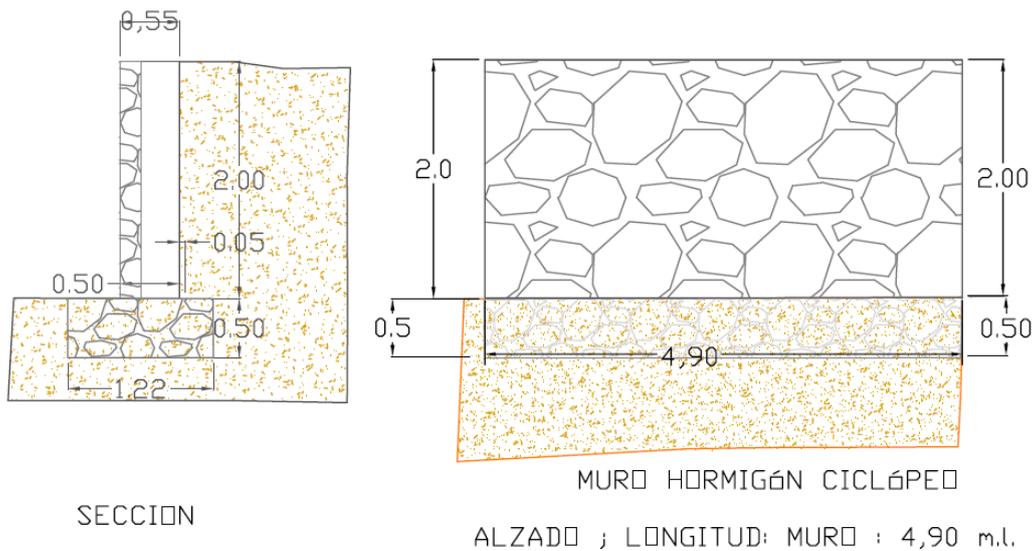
Plano nº6 Muros y vallados, planta, alzado y sección
